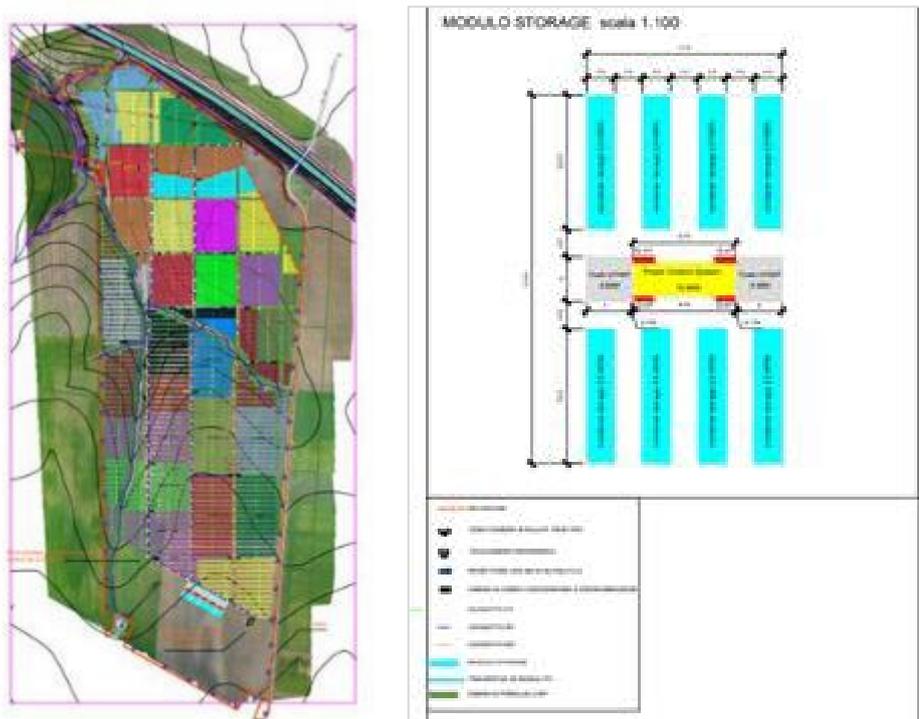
Individuazione su mappa dei Campi fotovoltaici e del gruppo storage (cfr. Planimetria Suddivisione in Campi doc. PIM01-Q-14)
